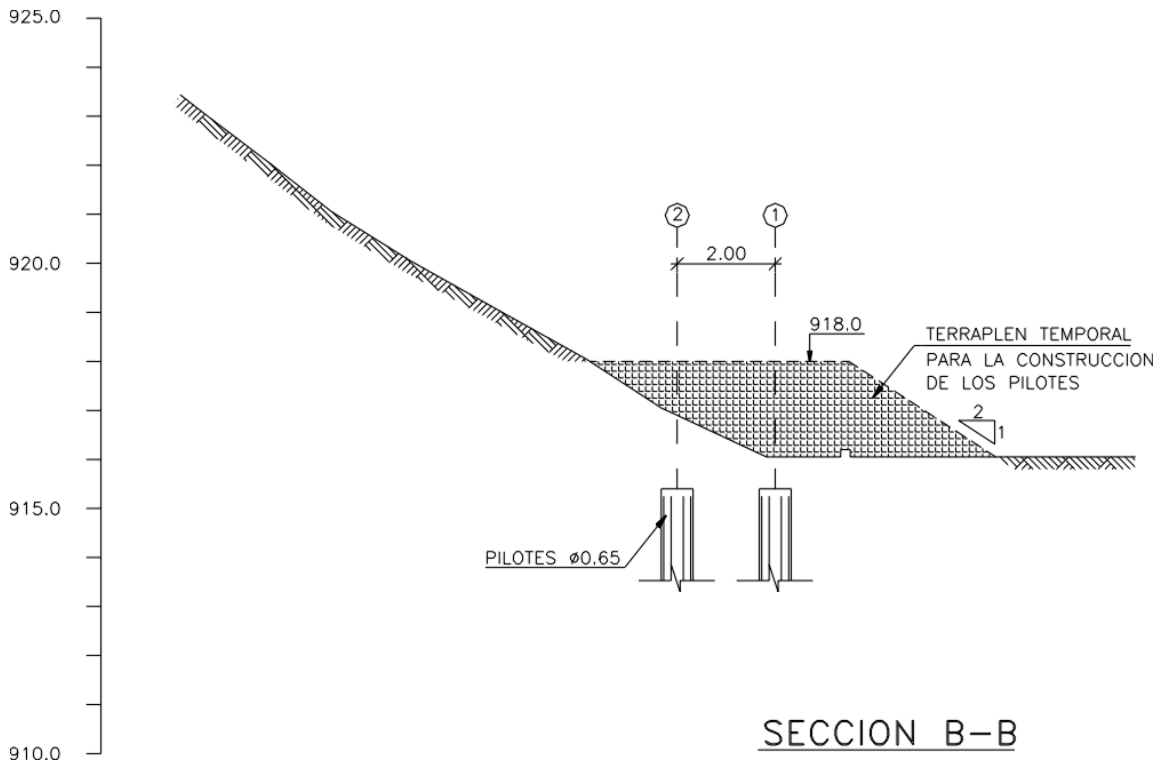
Construcción de terraplén temporal y vaciado de pilotes hasta cota inferior de cabezal.
